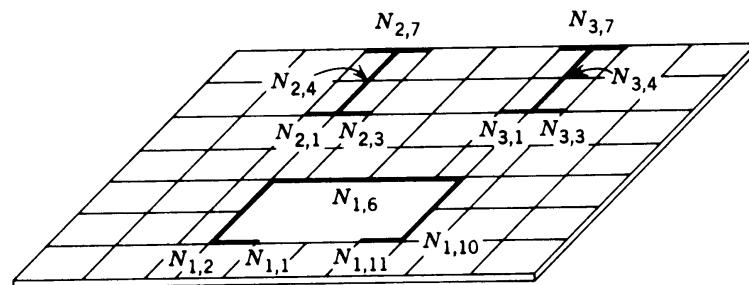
Discretização de um pavimento em elementos finitos – TARANATH (1968)
